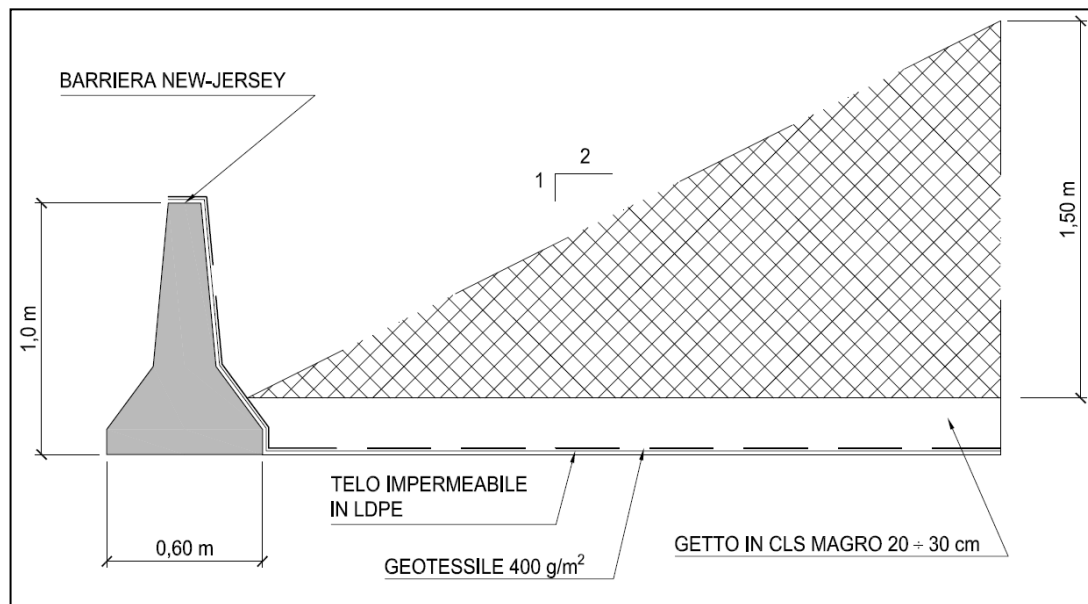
Sezione tipo per il confinamento e l’impermeabilizzazione dell’area di deposito temporaneo
